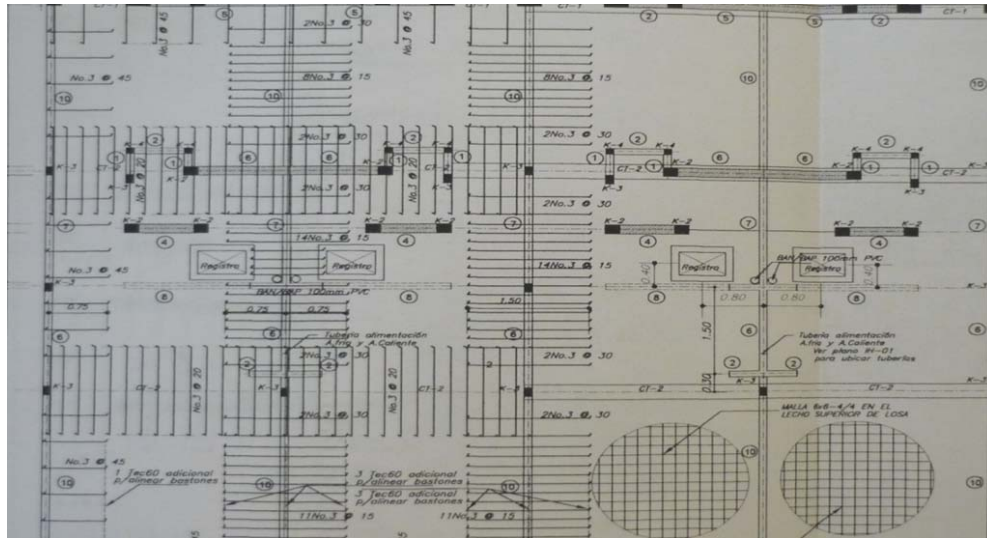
PLANTA DE CIMENTACIÓN
